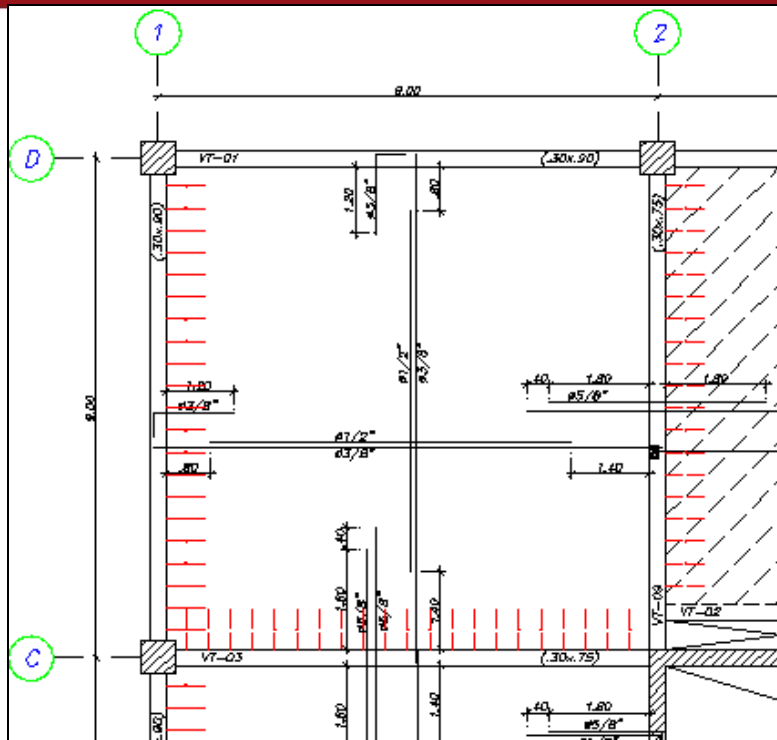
Armadura de losa aligerada armada en dos direcciones.
